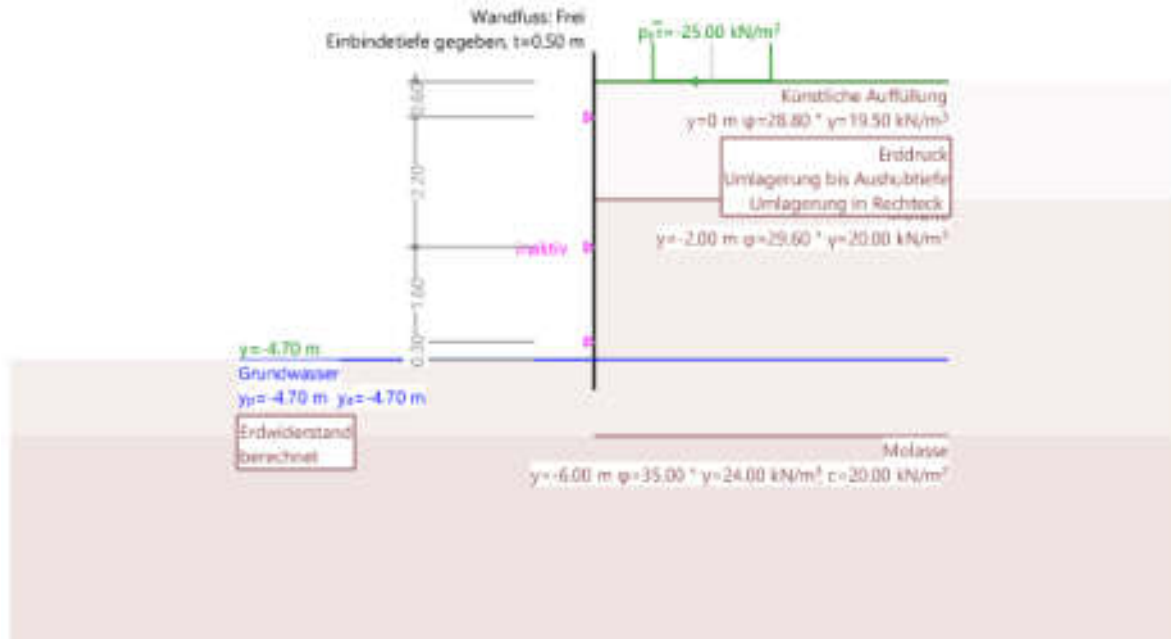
Baugrube nach Betonieren Bodenplatte
